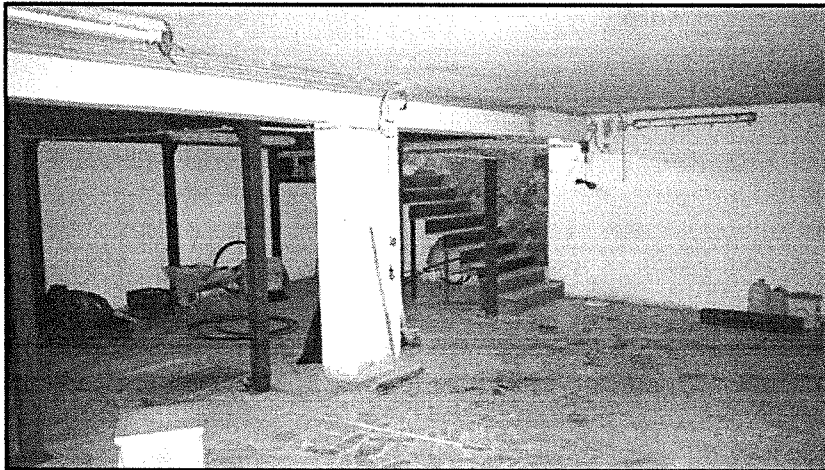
Locale parte bassa vista dall'ingresso con scala accesso soppalco
